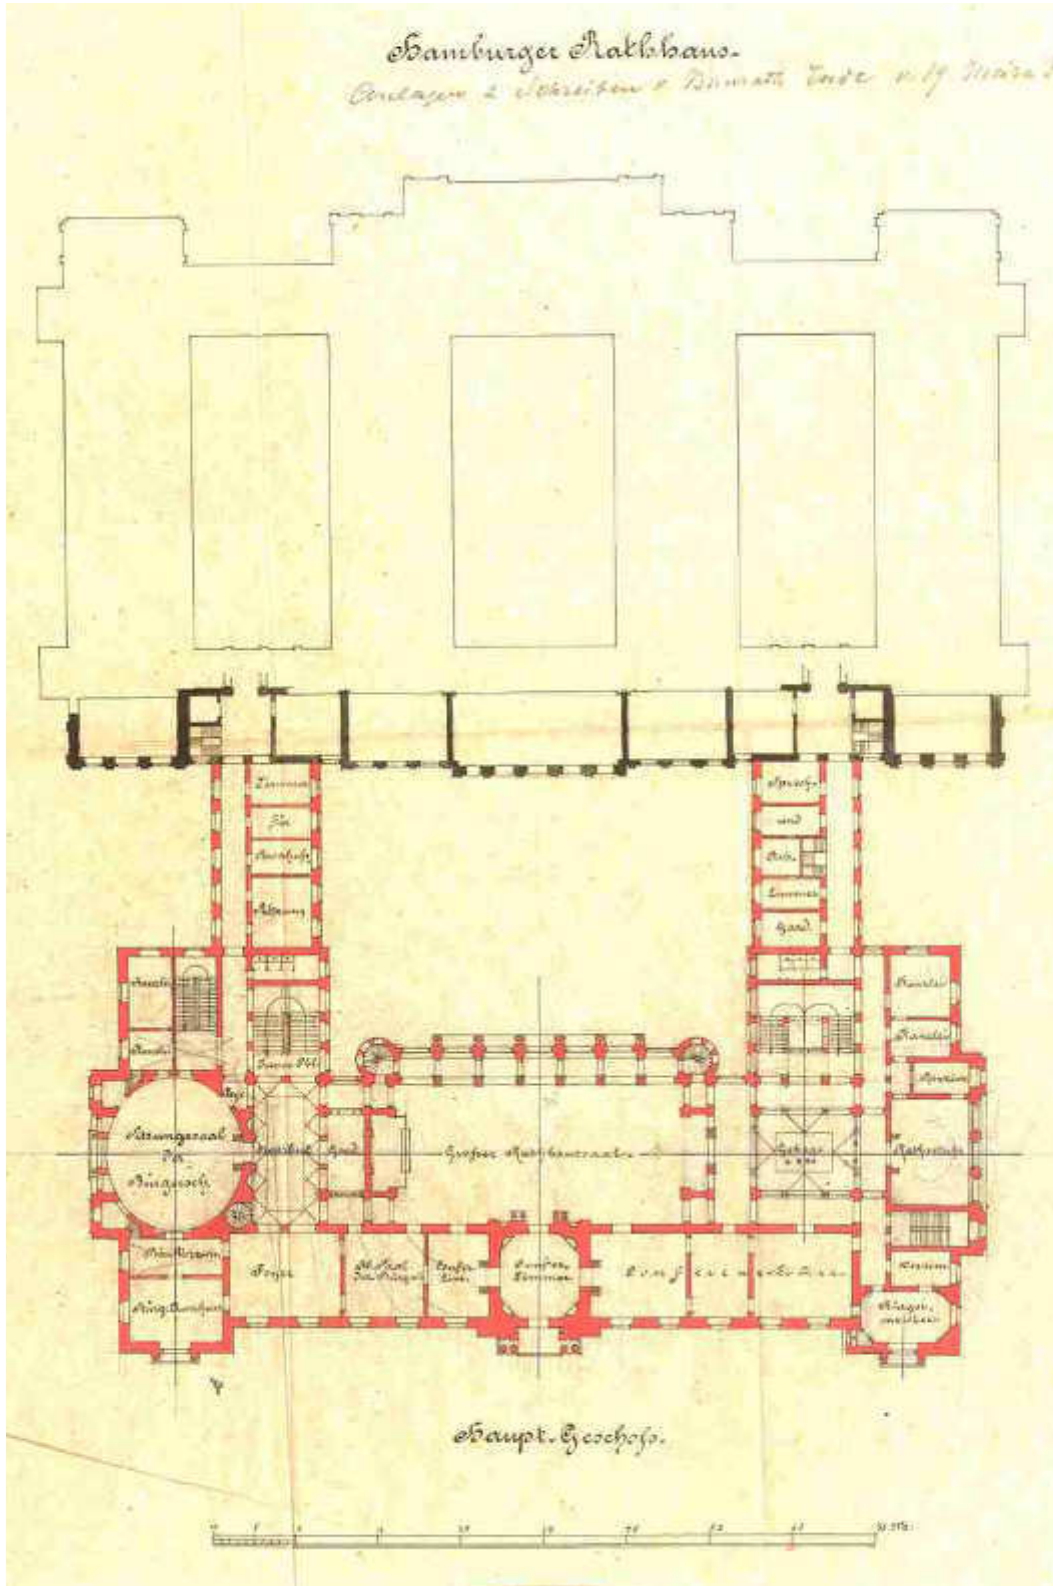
Grundriss Hauptgeschoss, abgeändert von Hermann Ende am 19. März 1884.
